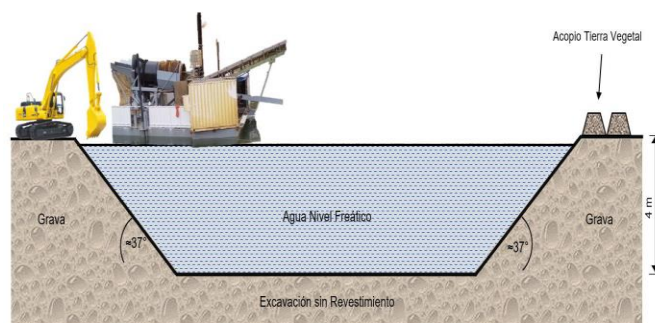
Planta Móvil-flotante dentro del reservorio)
